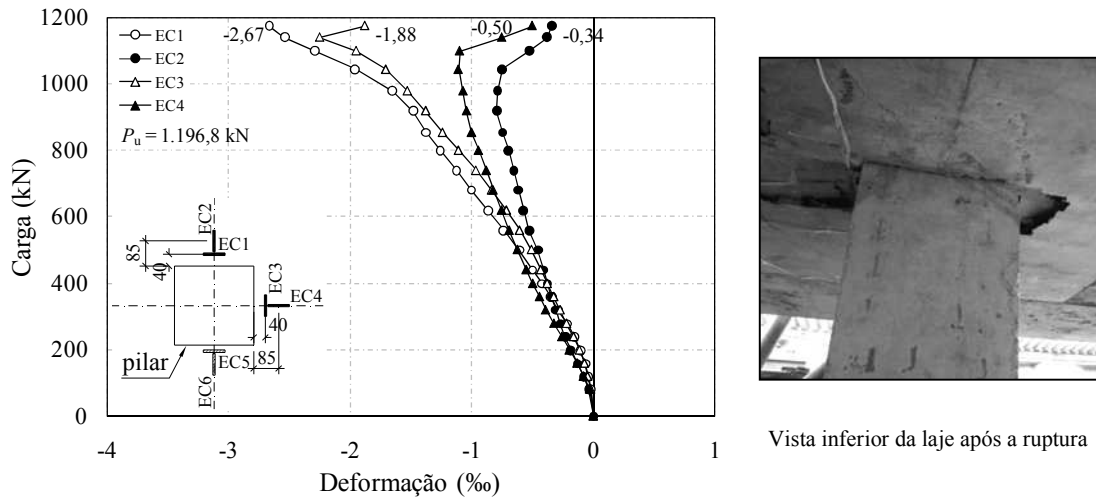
Deformações na superfície do concreto da laje LS07
